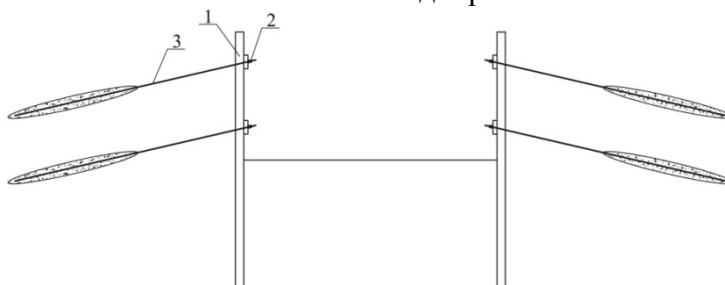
Крепление стен глубокого котлована грунтовыми анкерами:
